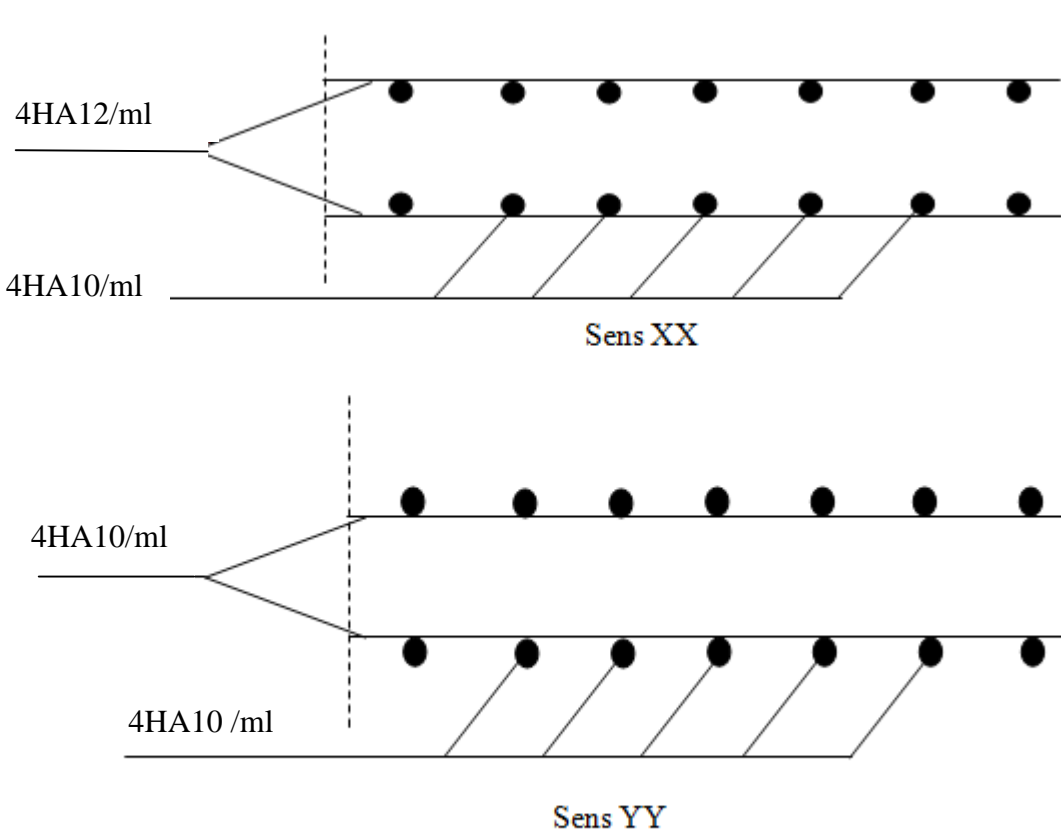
ferrailage de la dalle pleine (dalle salle machine)
